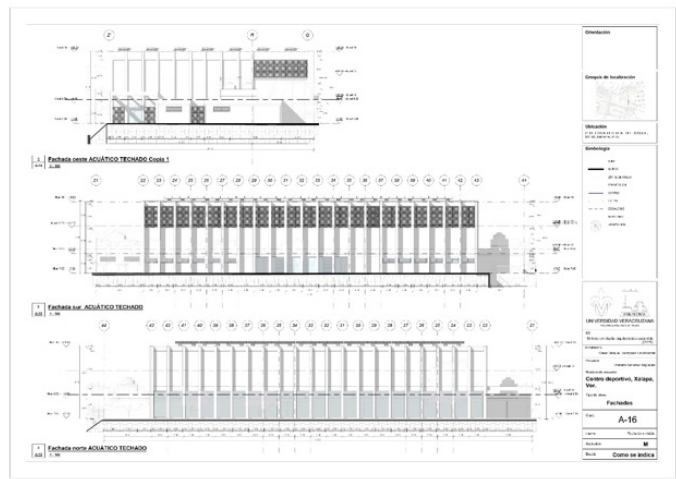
Plano de Plantas Arquitectónicas de Sanchez Argüelles Roberto
